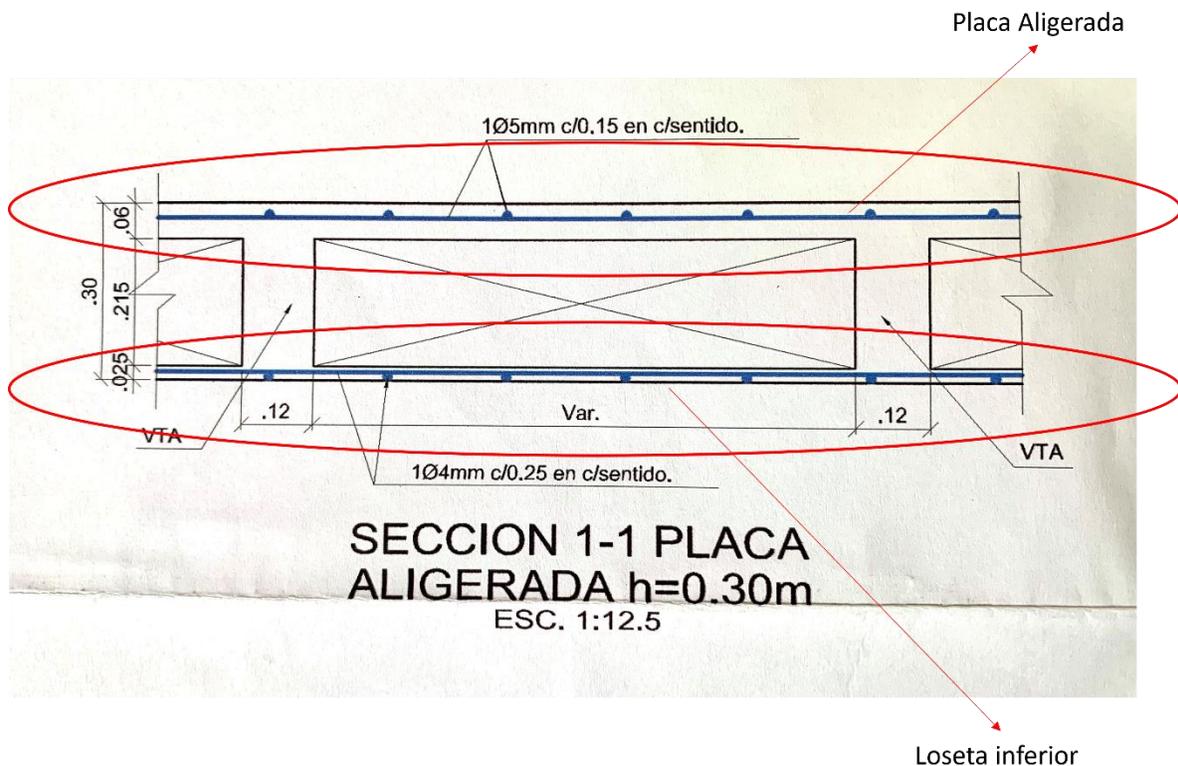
Detalle plano estructural. Corte Placa Parquaderos.
